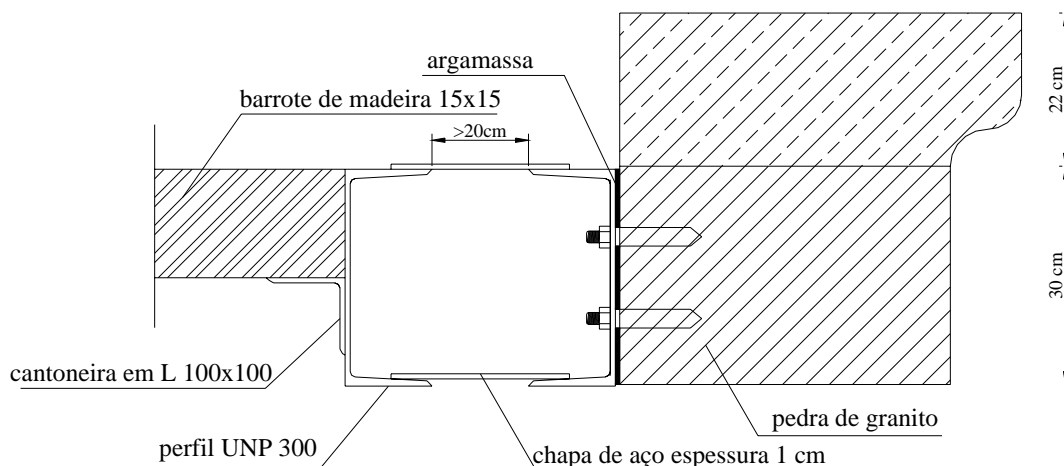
[4c]: Corte tipo da estrutura metálica, substituída pela viga de madeira
